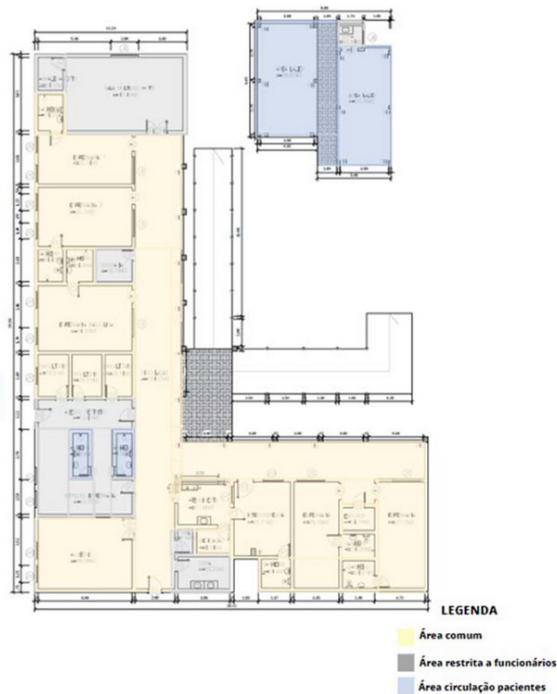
PLANTA BAIXA UNIDADE DE DESINTOXICAÇÃO.
